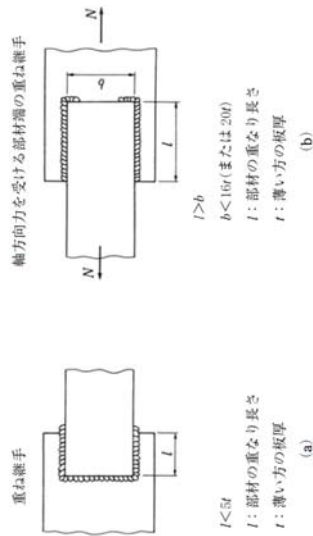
重ね継手のすみ肉溶接
